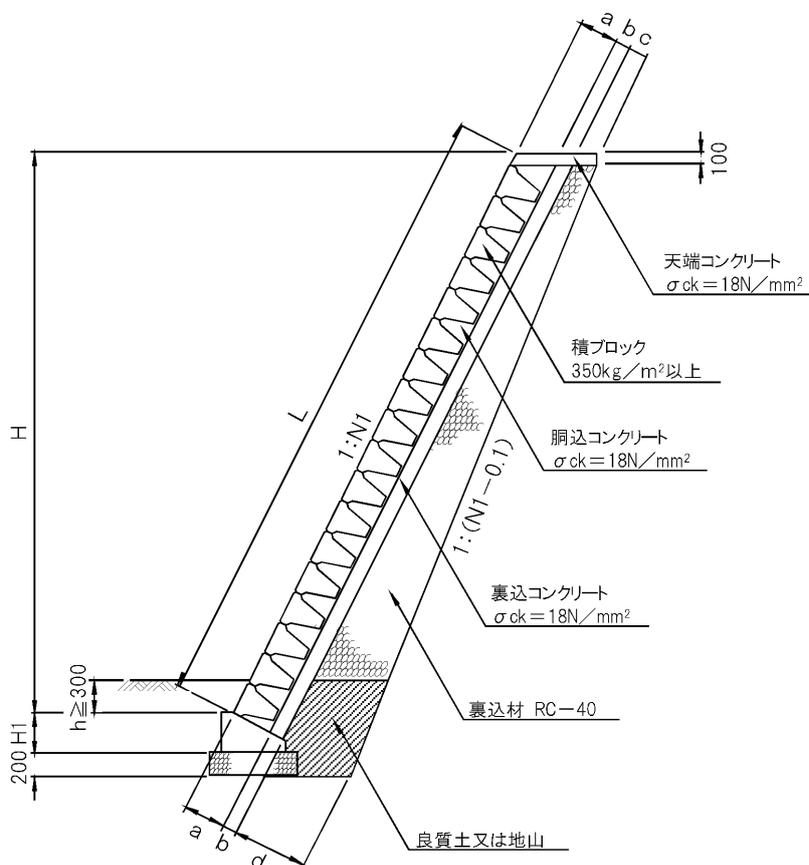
ブロック積擁壁の標準断面 (出典：小構造物標準設計図集 (鳥取県県土整備部))
